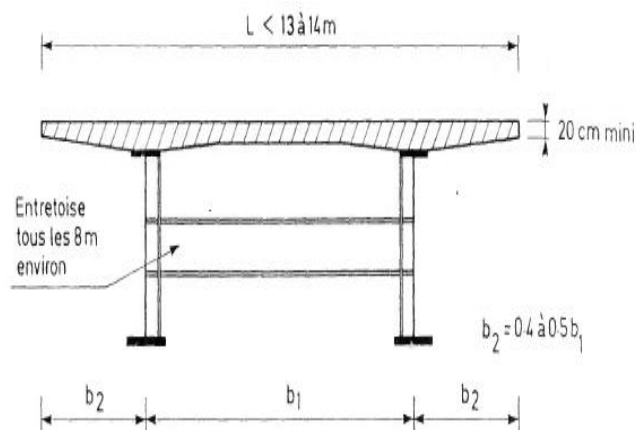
Coupe transversale de la variante 1 (SETRA, 1985).
